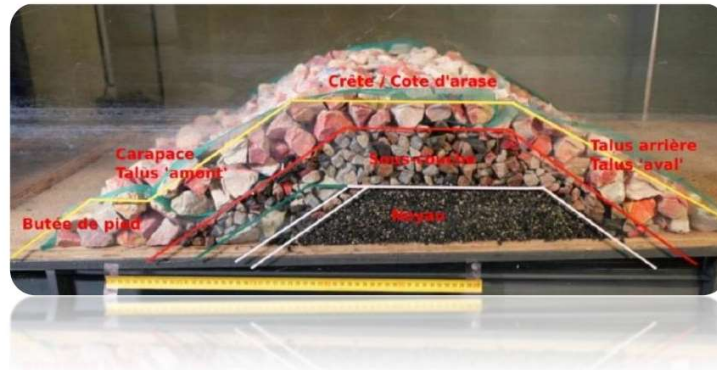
Coupe digue testée en canal à houle (Builders, 2025)
